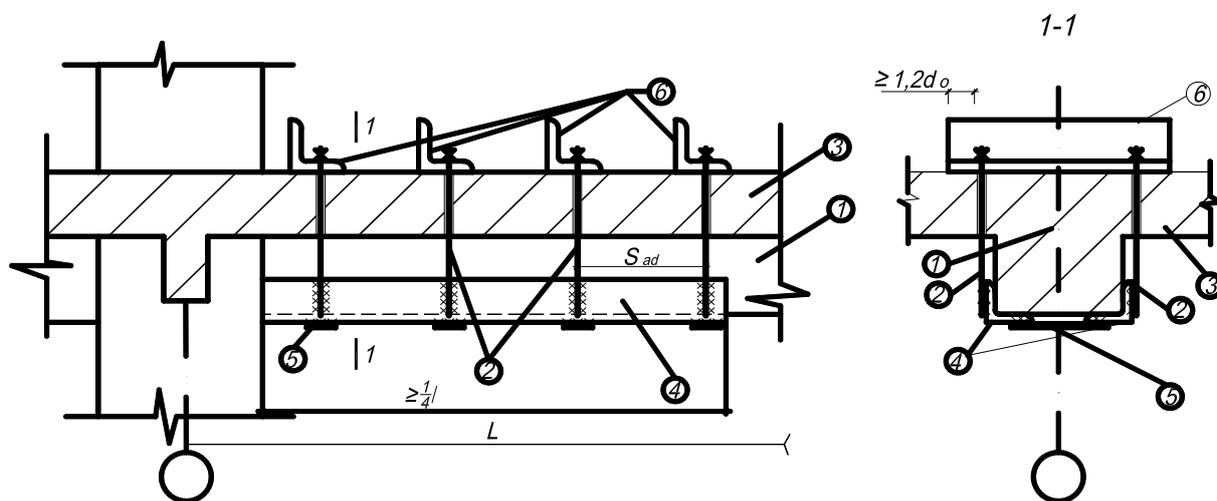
Расчетная схема усиления балок по наклонному сечению хомутами:
